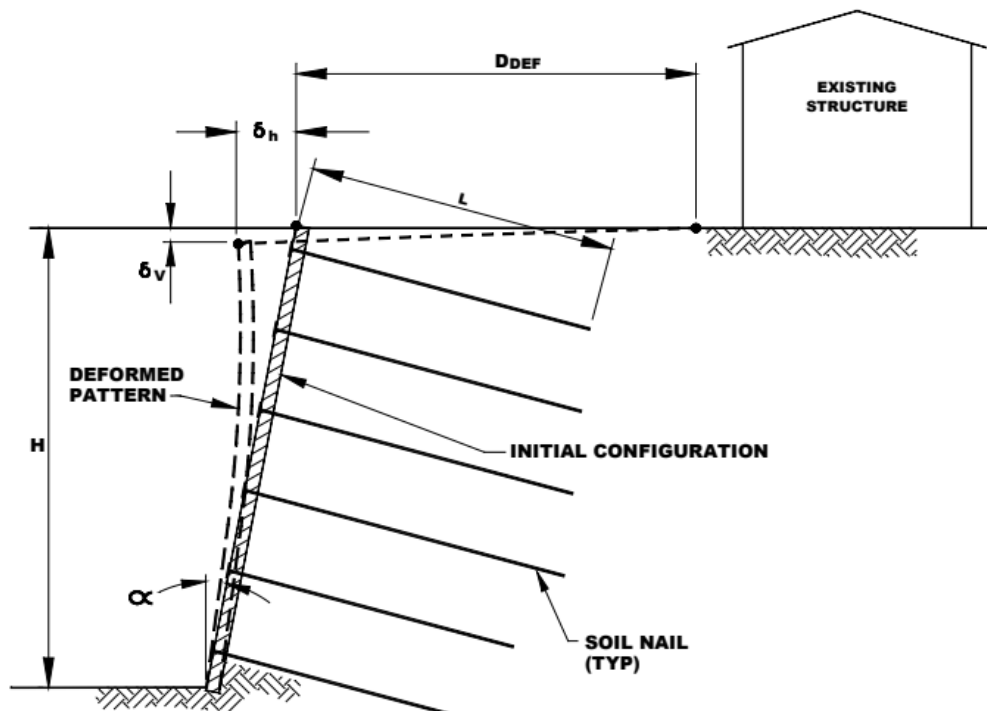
Deformaciones en un muro de suelo claveteado (Fuente: *Manual for Design & Construction Monitoring of Soil Nail Walls* (FHWA, 1998))
